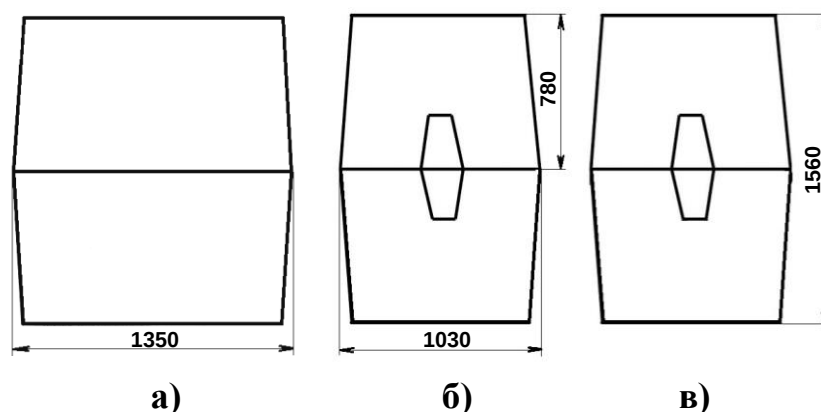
Габаритные размеры колодца «ККСр-2-10(80)»:
